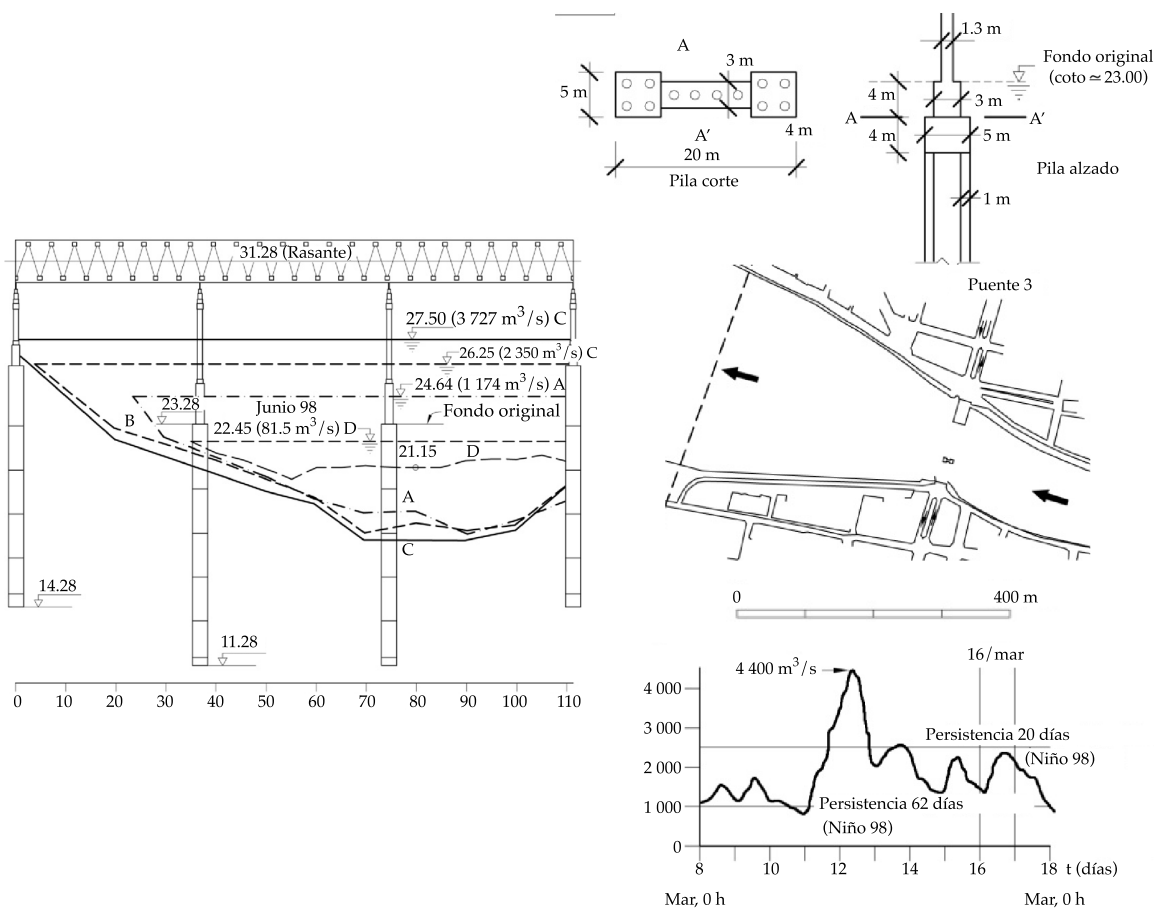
Izquierda: sección transversal del río por el puente de Piura, que resistió, con la evolución del fondo, durante El Niño de 1998 (cimentación de cajones). Derecha: planta y alzado de la pila con cimentación profunda de pilotes (arriba) y posición en planta del puente que no resistió (centro), e hidrograma de El Niño de 1998 (abajo).
